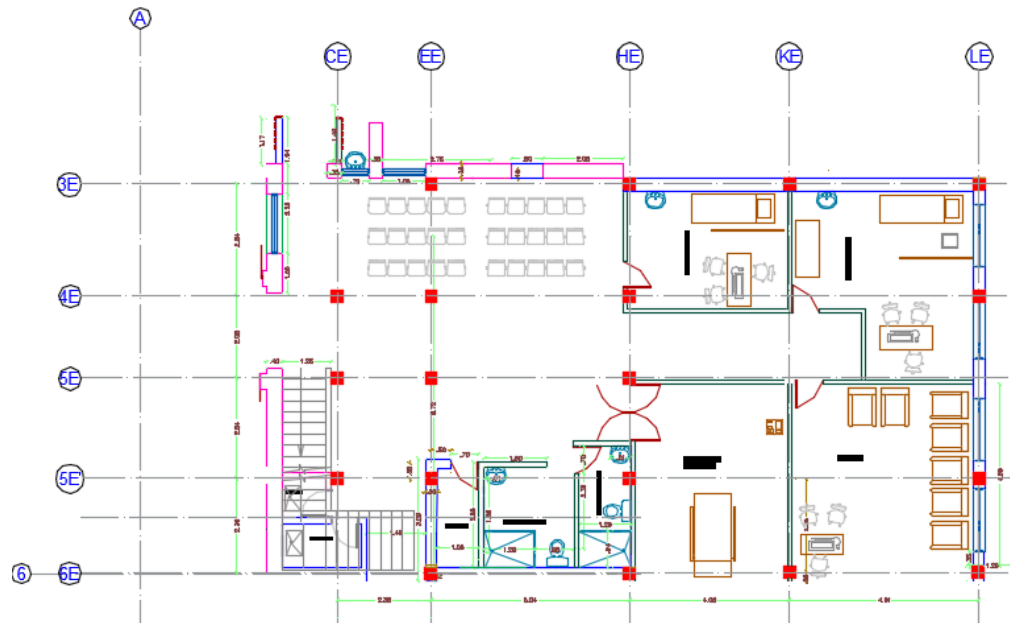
Planta Estructural y arquitectónica de la Zona A, planta primer piso. Fuente: Autor.
